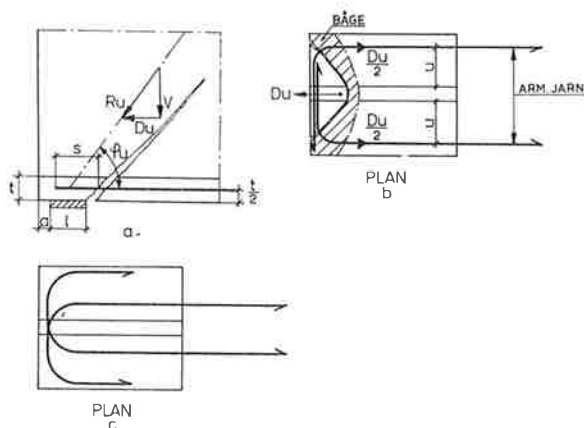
Brottfigurer i en väggskivas underfläns. • Fracture patterns. Lower flange of an I element.
